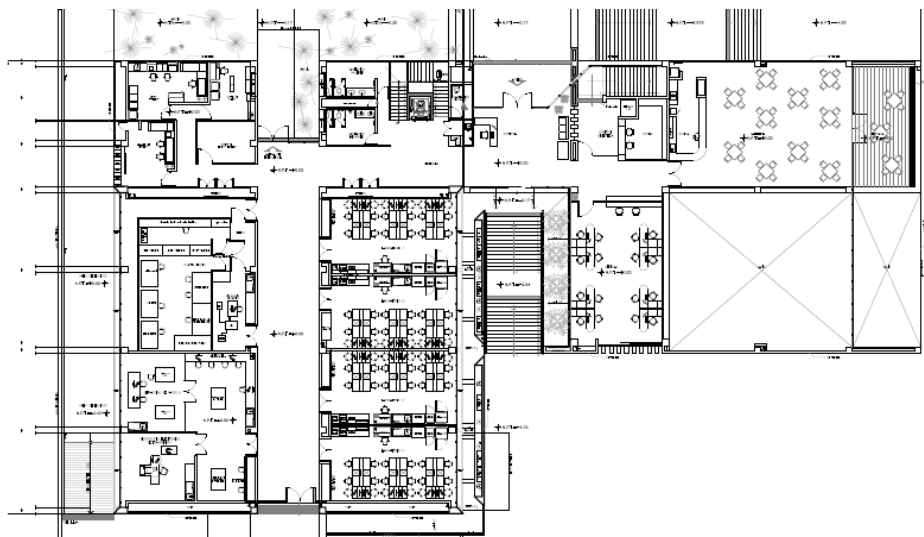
planta baja del CNYN. Recuperada de planos originales.
